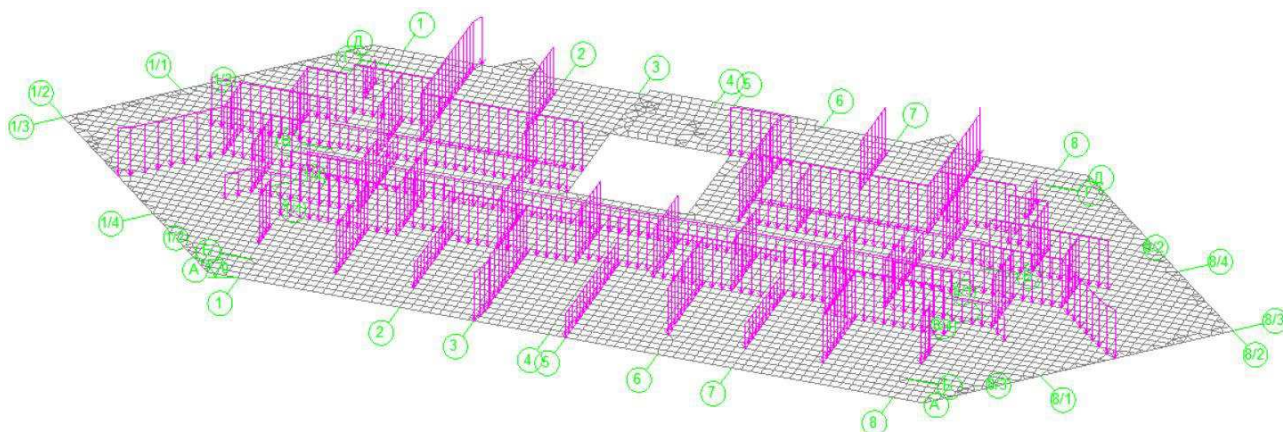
Загрузка плиты перекрытия весом перегородок
